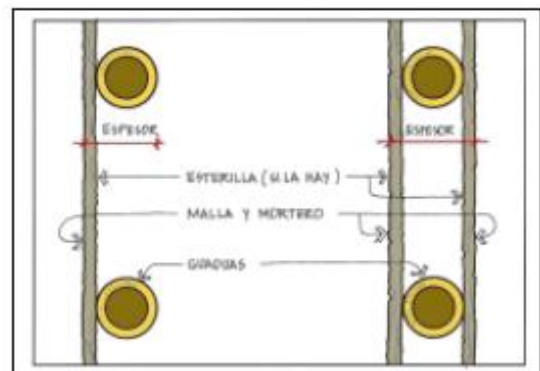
Detalle de Muros no estructurales de Bahareque.
